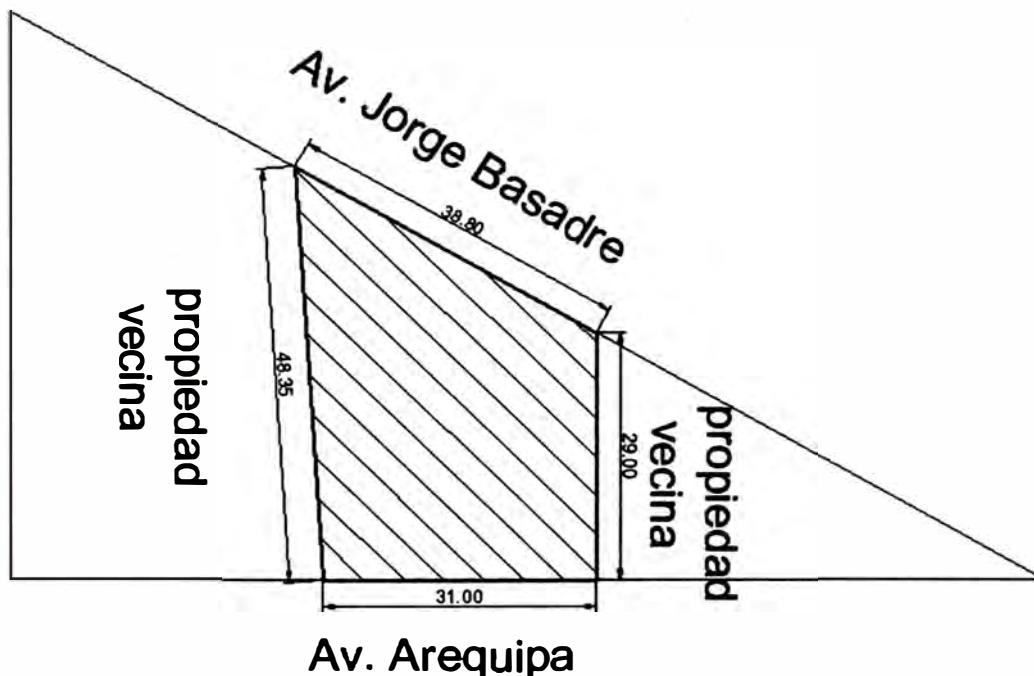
Vista en planta del terreno del Edificio Comercial Basadre
